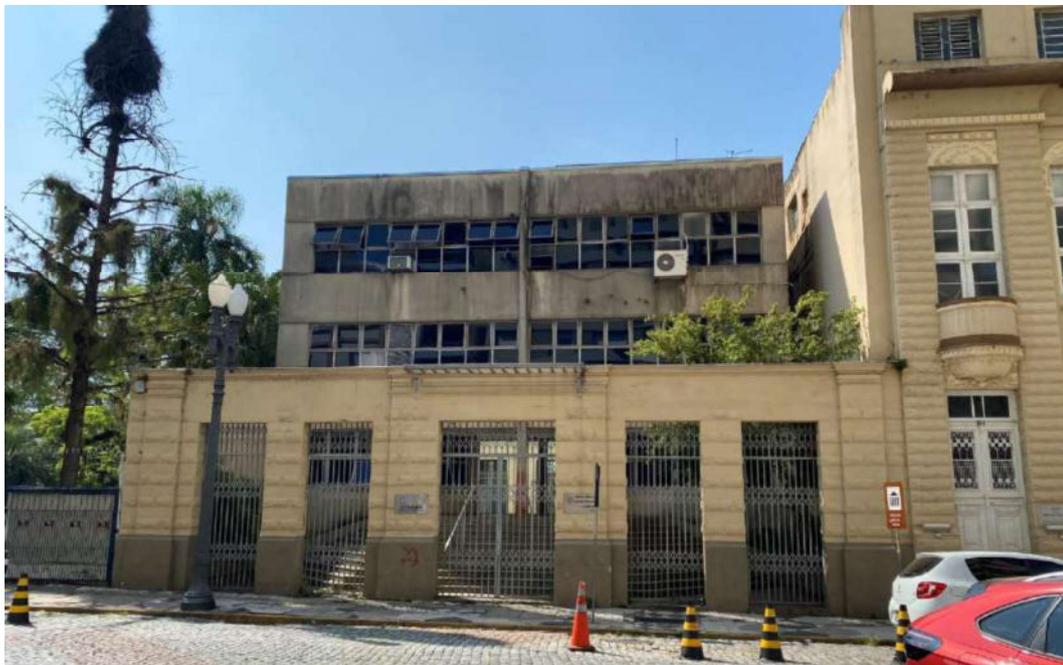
Visão geral – Presença de mofo/bolor na fachada principal do prédio do DA pavimento térreo
